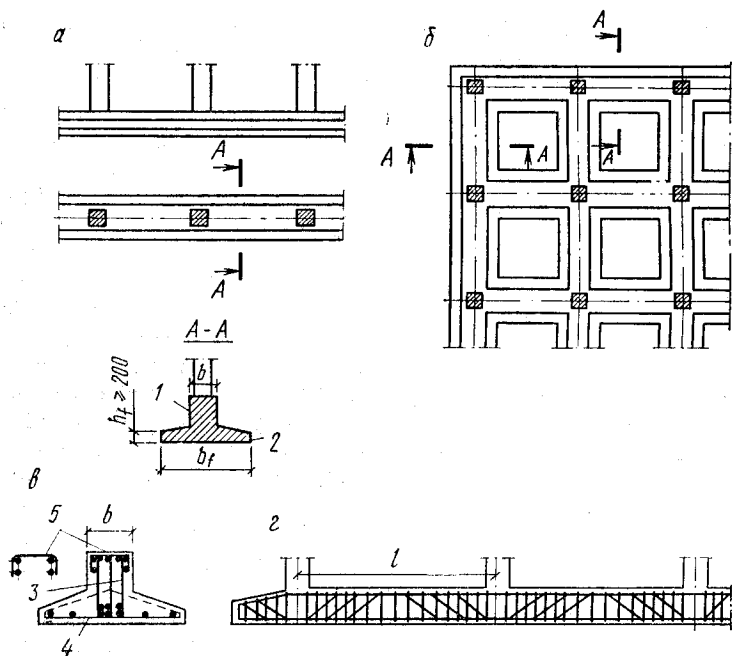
Ленточные монолитные фундаменты под колоннами
